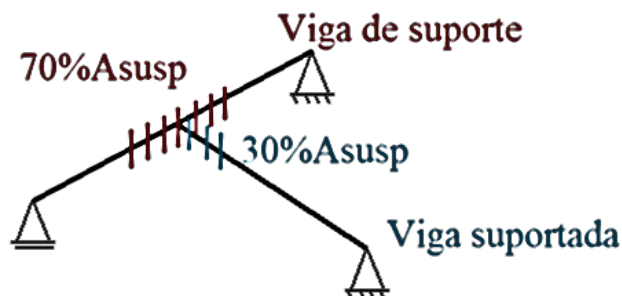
Armadura de suspensão para vigas suportada e de suporte
